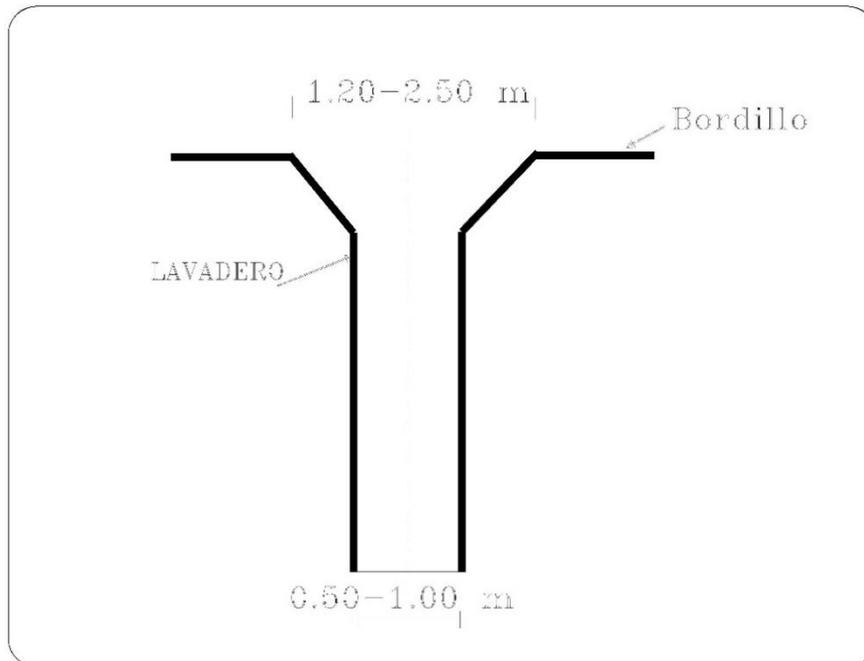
VISTA DE LAVADERO EN PLANTA
